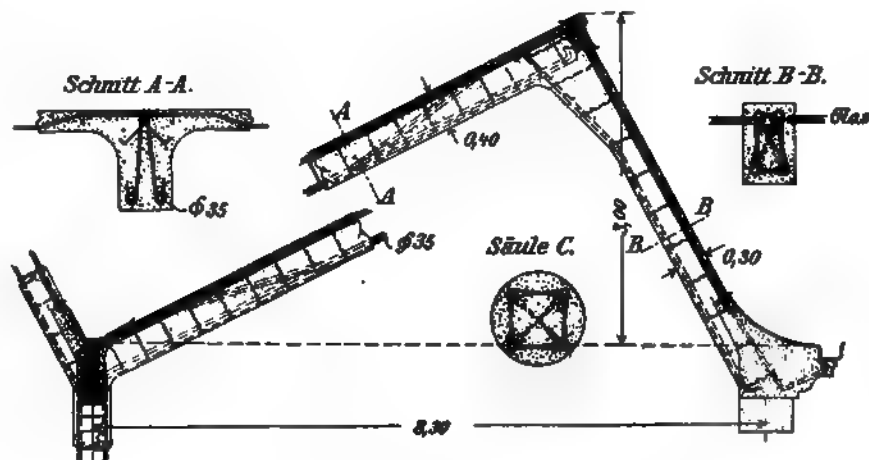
bis 137. Baueinheiten zu Abb. 133.
